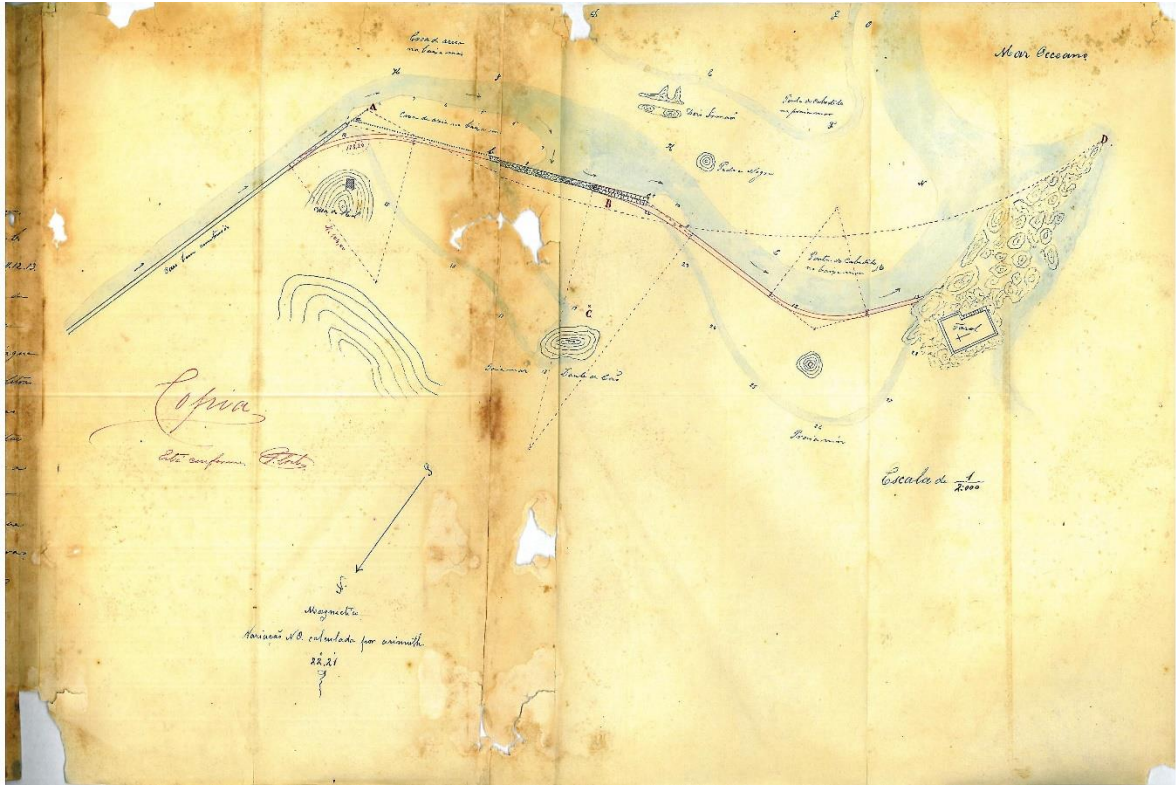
Planta da Barra de Vila do Conde em 1870.
